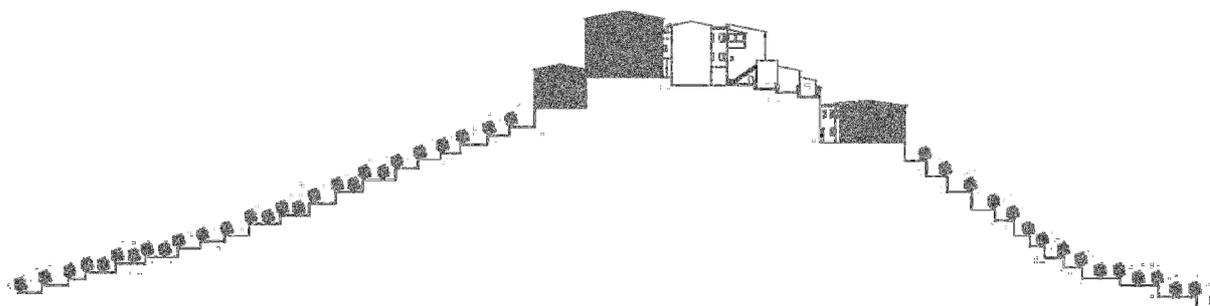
Sezione urbana C-C (Fonte: Tavola 2D)
